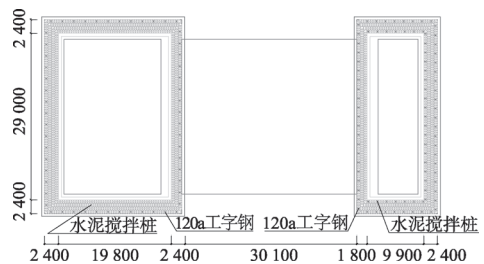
基坑支护水泥搅拌桩平面布置（单位：mm）
